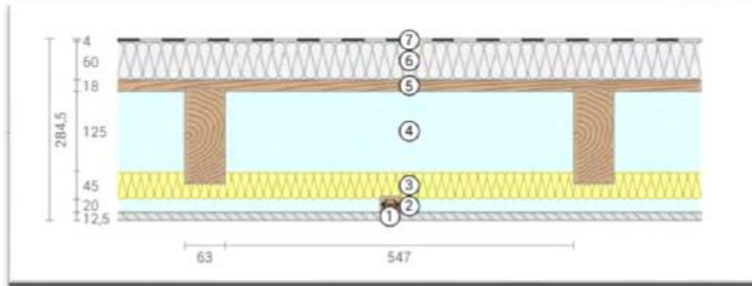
P02 Plat dak met SuperQuilt tussen de balkconstructie
